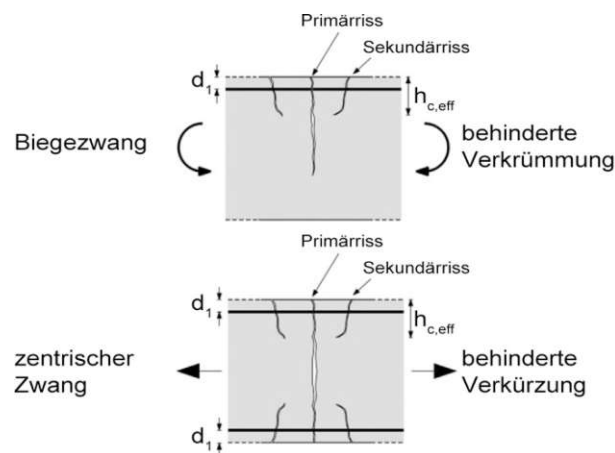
Rissysteme je nach Zwangsbeanspruchung, bestehend aus geometrisch vorgegebenem Primärriss und Sekundärrissen infolge der Bewehrung; Darstellung nach [SCHLICKE und TUE (2016); S. 122 – Bild 3]
